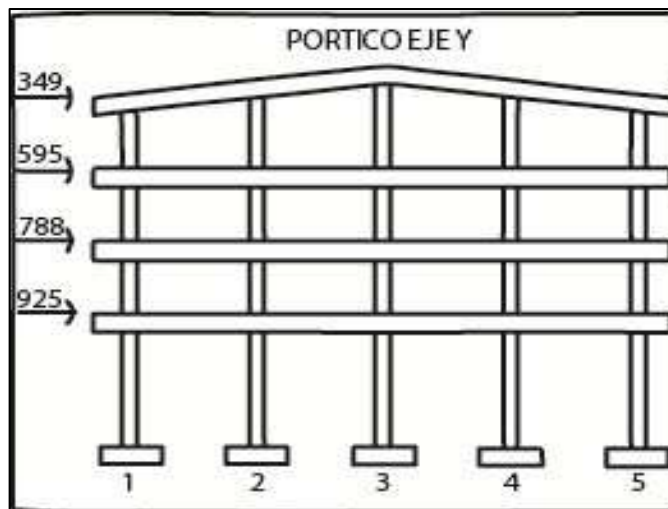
Ilustración de fuerzas cortantes que actúan en la estructura (Eje Y); Fuente: [Grupo investigador]
